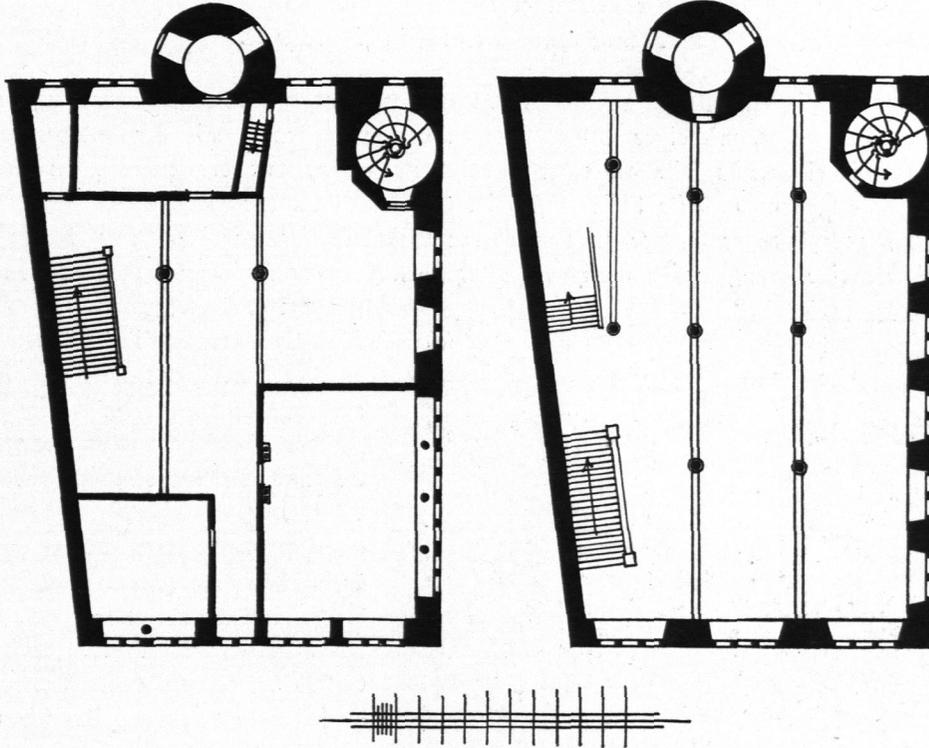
Rathaus zu Kitzingen. Grundrisse des ersten und zweiten Stockwerks.
